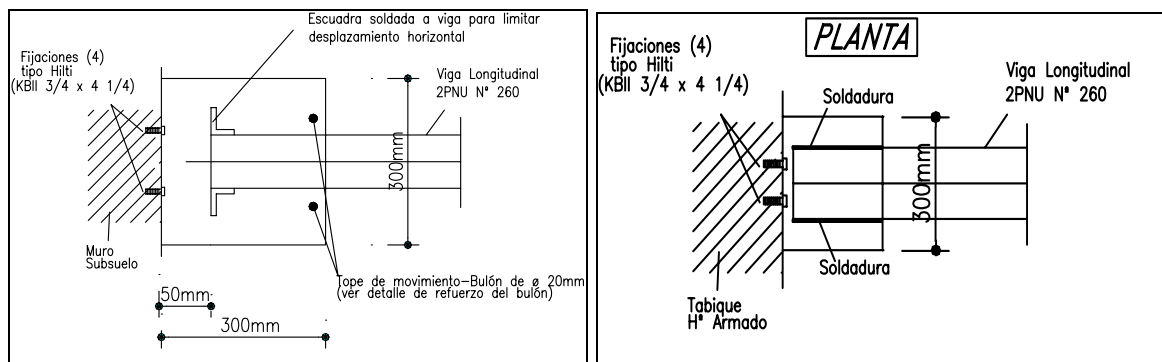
Detalles de la conexión de las escaleras metálicas a los edificios y en particular para la torre con aislamiento sísmico.(Ver también capítulo 9)
